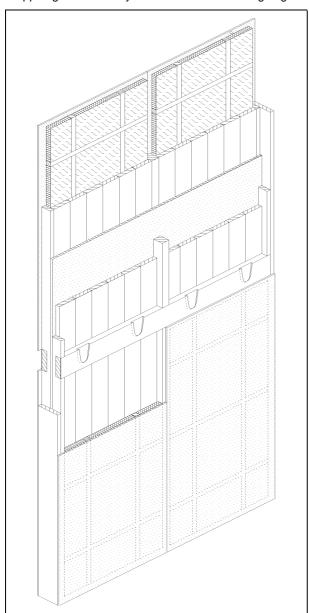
Wandaufbau mit Vorsatzschale
